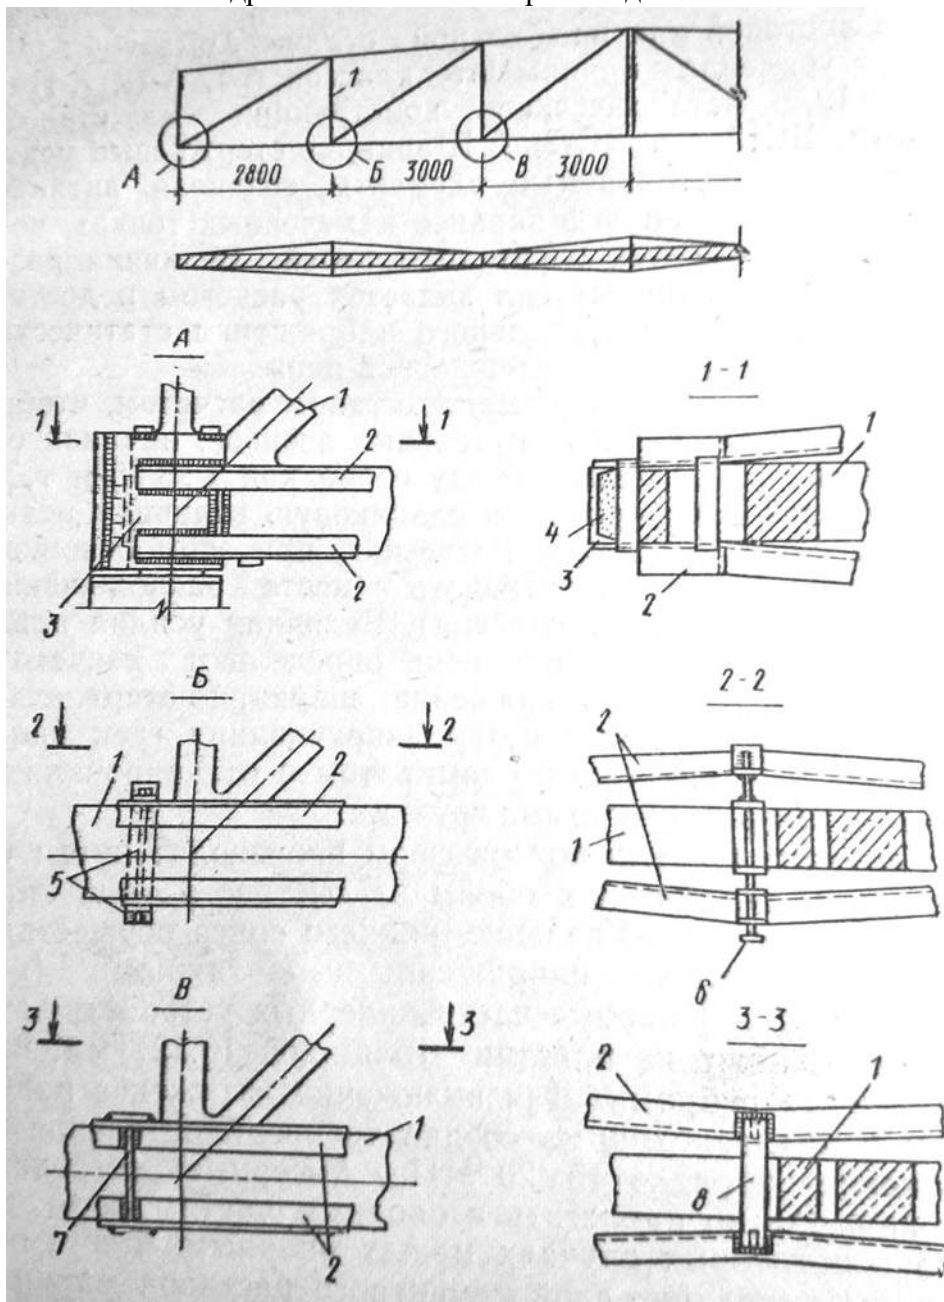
Усиление нижнего пояса ферм затяжками из уголков:
